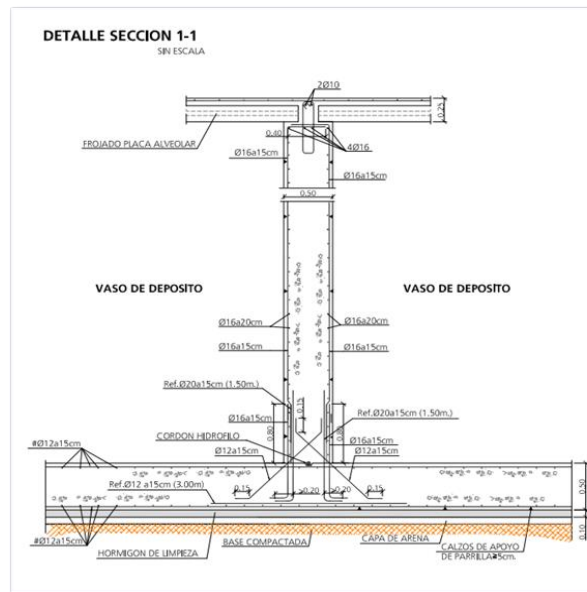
Detalle de arranque de muros perimetrales y solera: muro central
